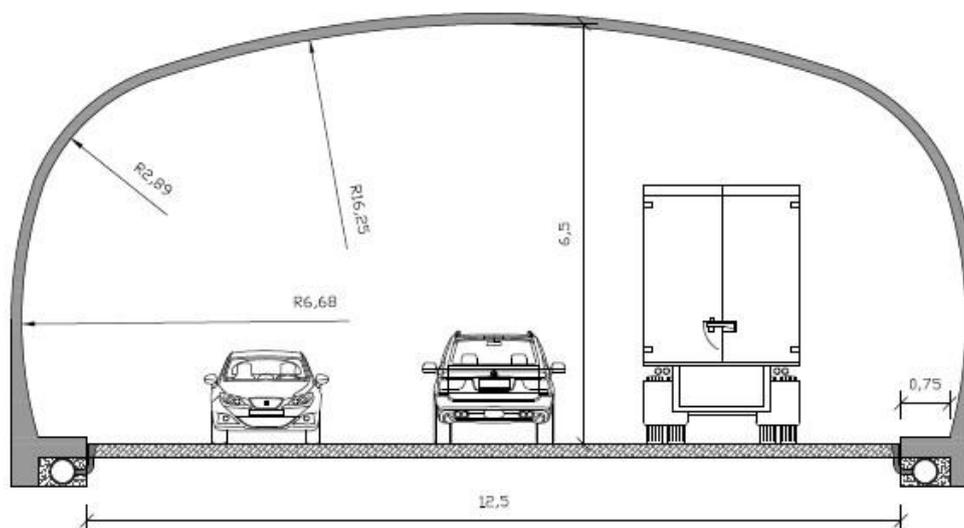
Sección transversal del túnel 1 y del túnel 4
